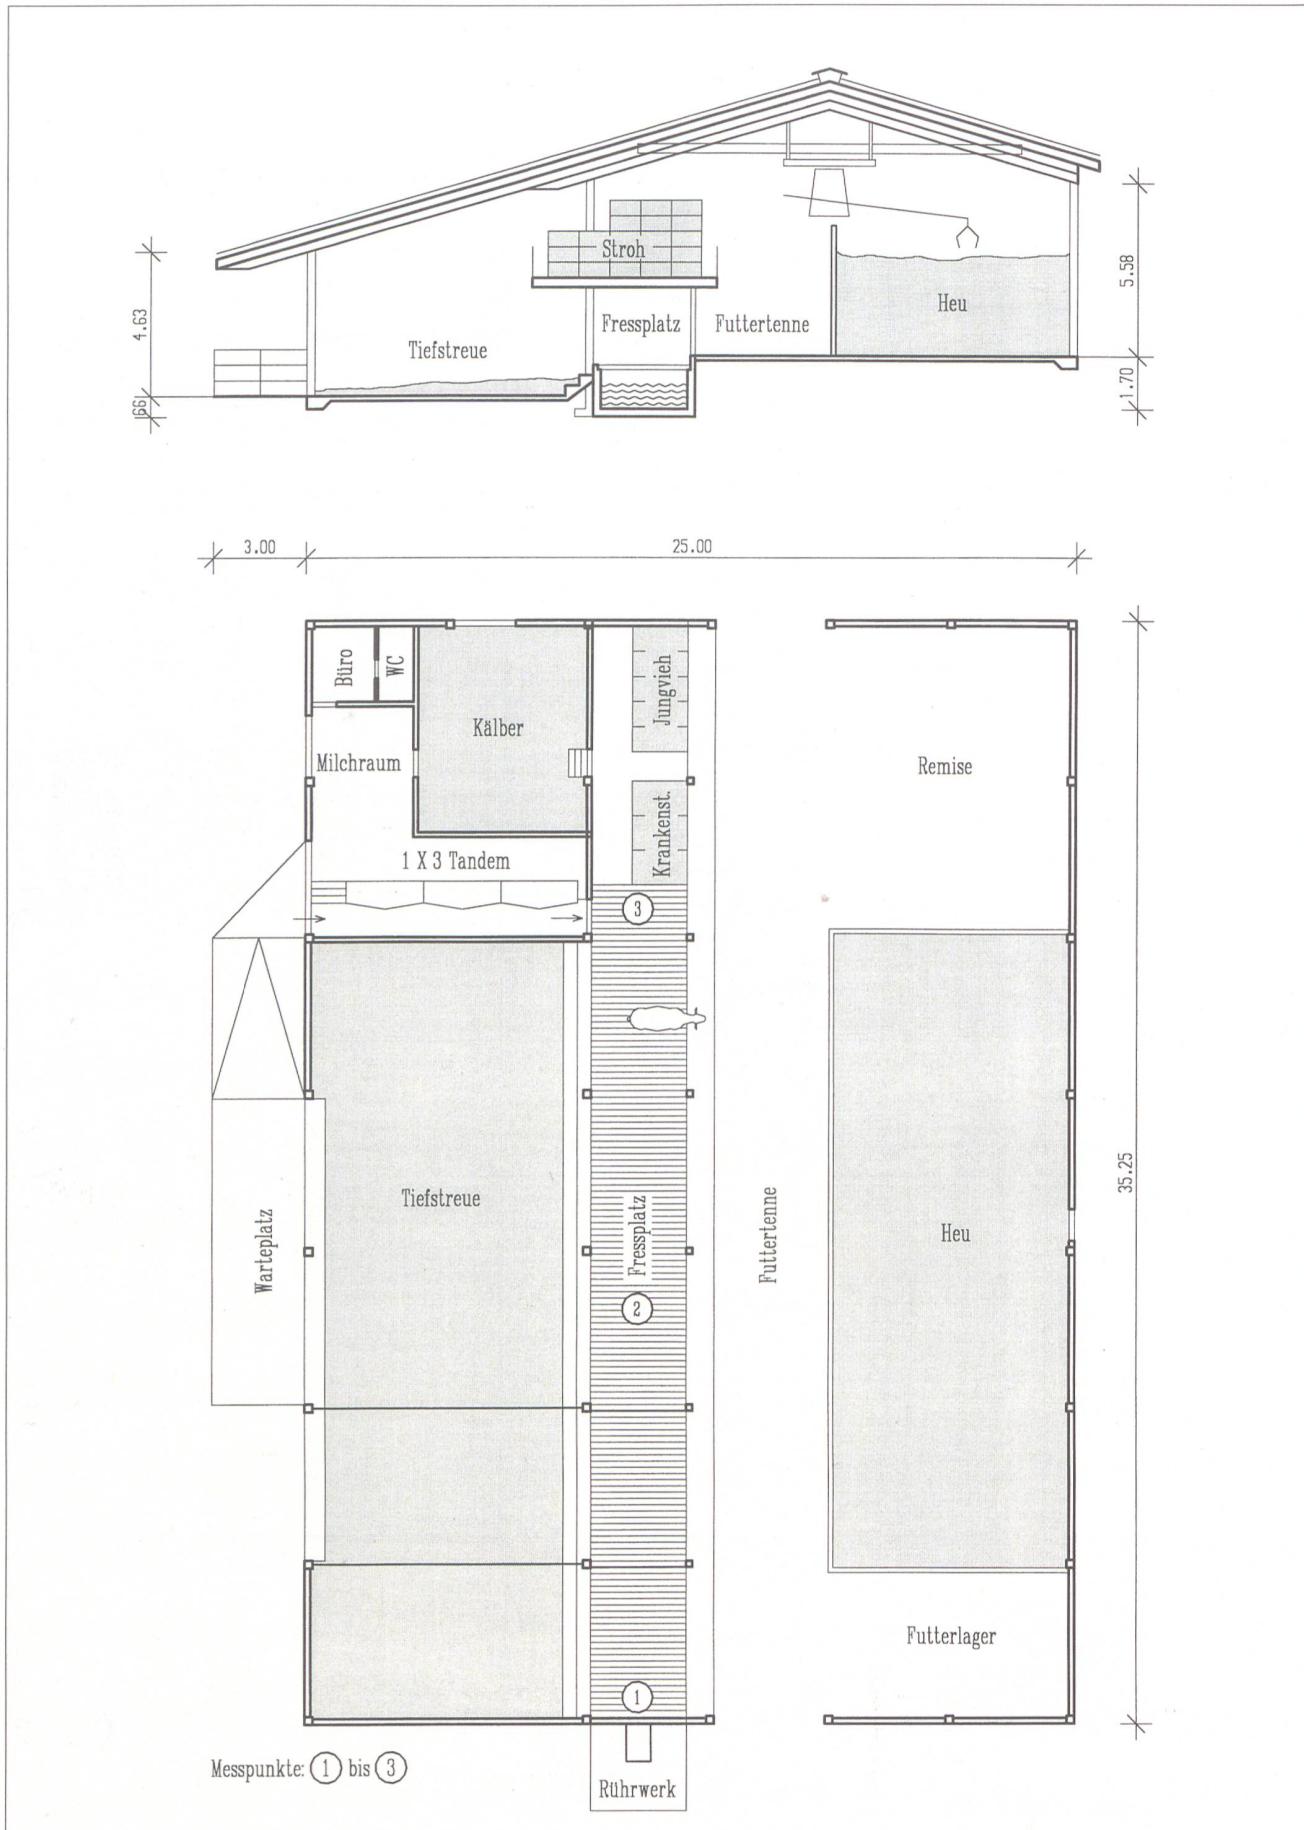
Güllegrube unter Fressplatz, Stall einseitig offen.
